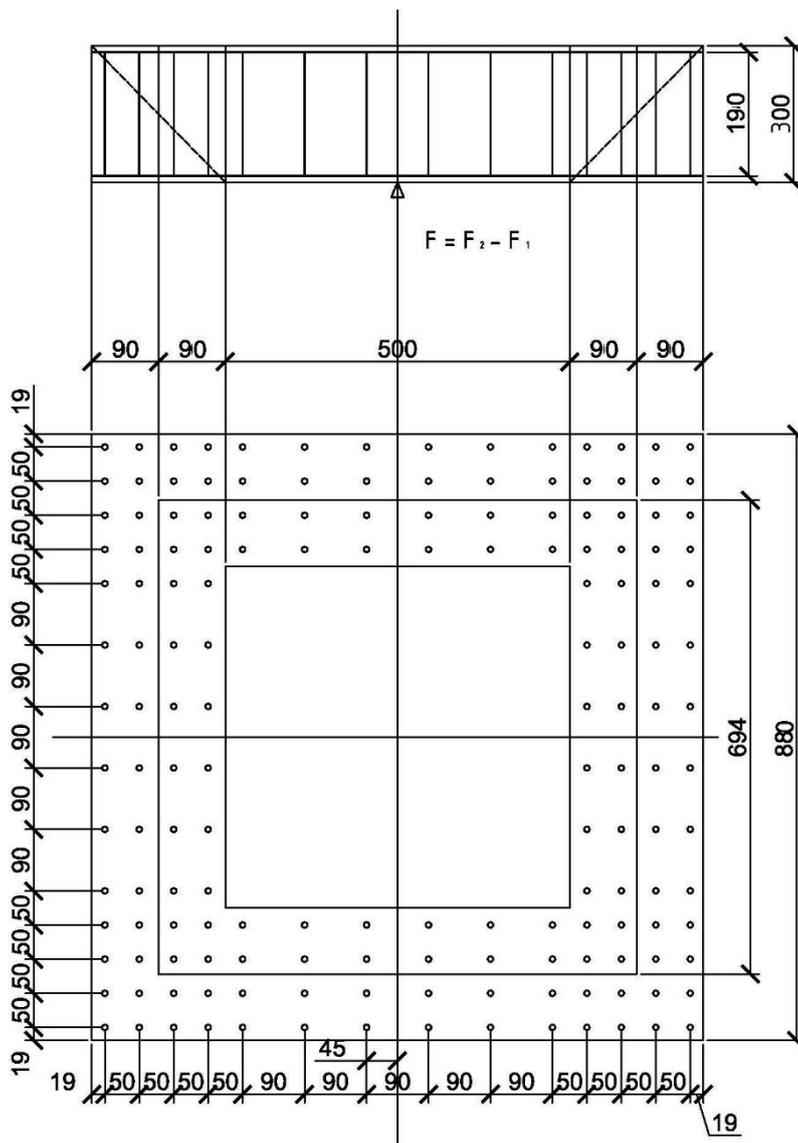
Схема для расчета железобетонной плиты с поперечной арматурой на продавливание
